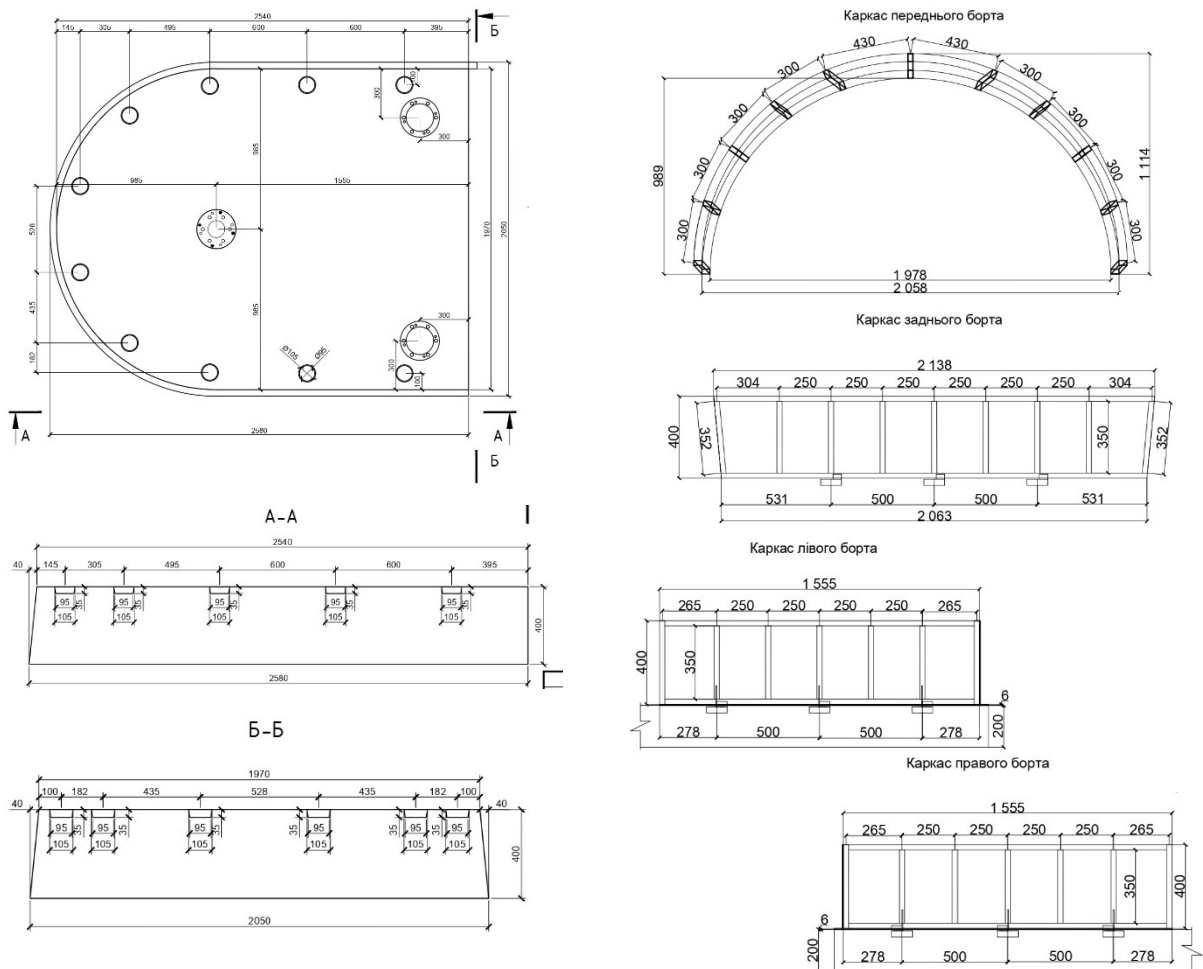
Фрагменти креслення опалубки для RS REF 400.203
